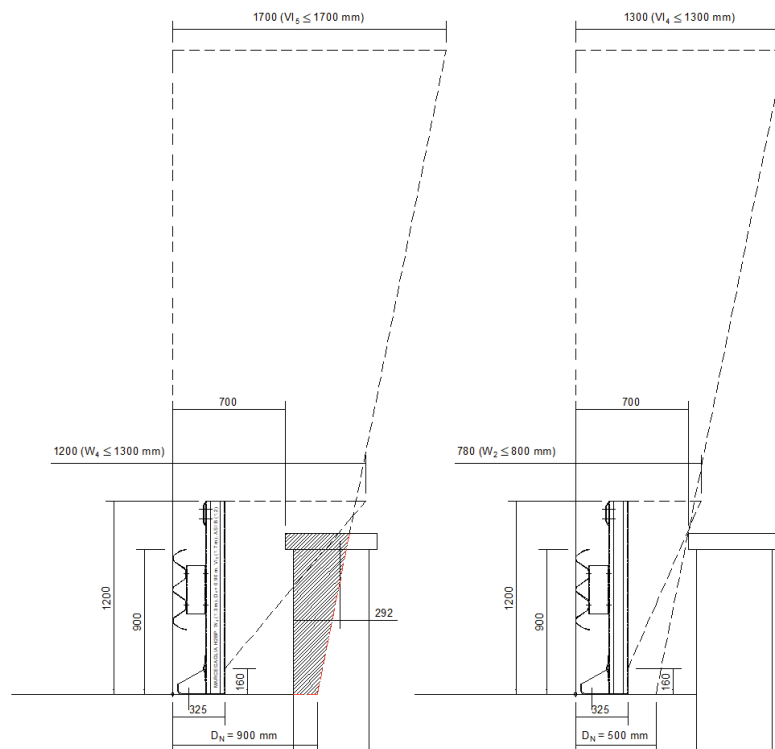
Sezioni tipiche in corrispondenza del muretto presente alle spalle del ponte
